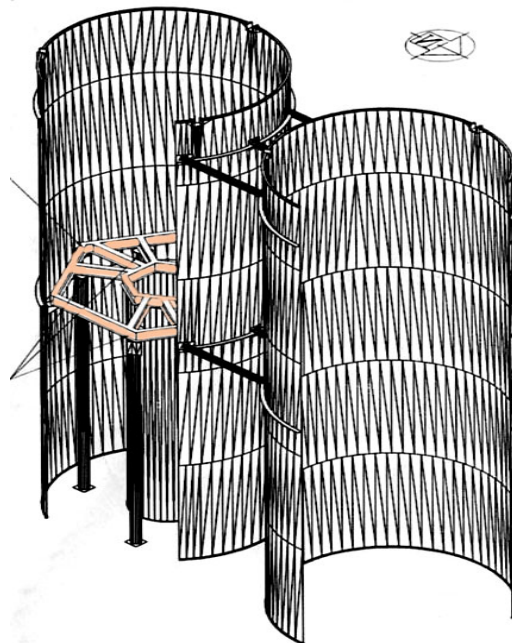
Detalle de plantilla soporte suministrada por el fabricante de los ciclones.
